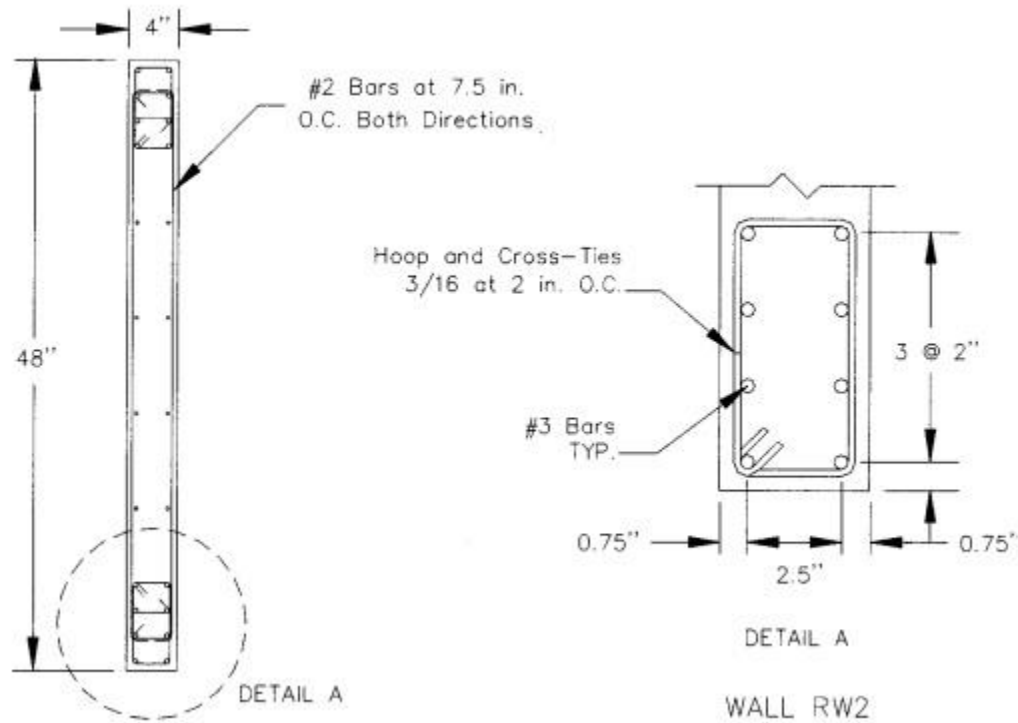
Detalles de armaduras en muro RW2 [19] (1 in. = 25.4 mm).
